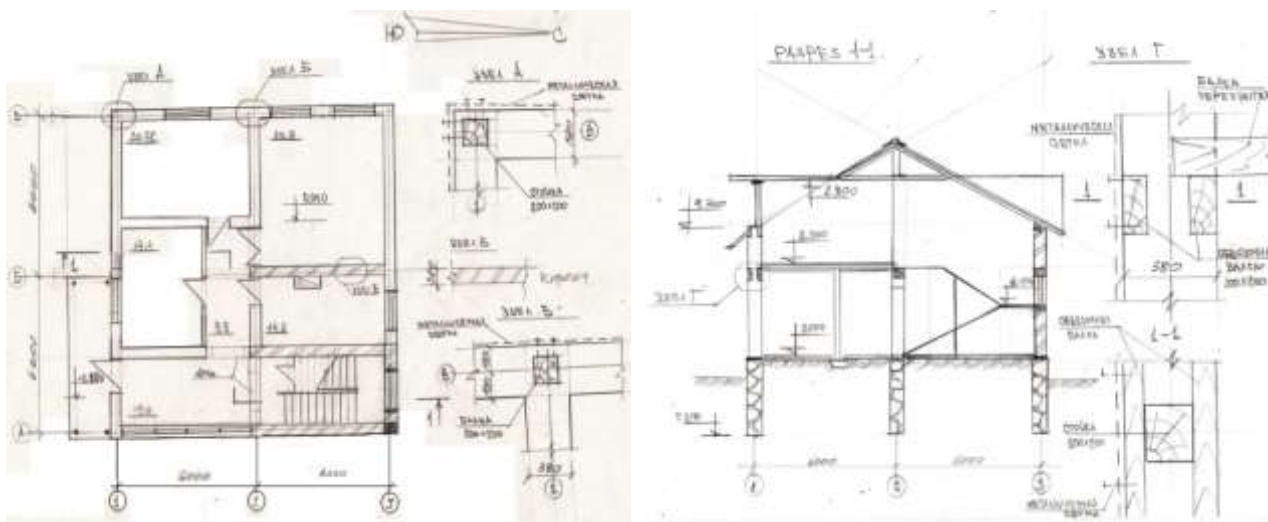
План и разрез двухэтажного жилого дома с деревянным каркасом, стены из фиброблока. а - план первого этажа, б – разрез.
